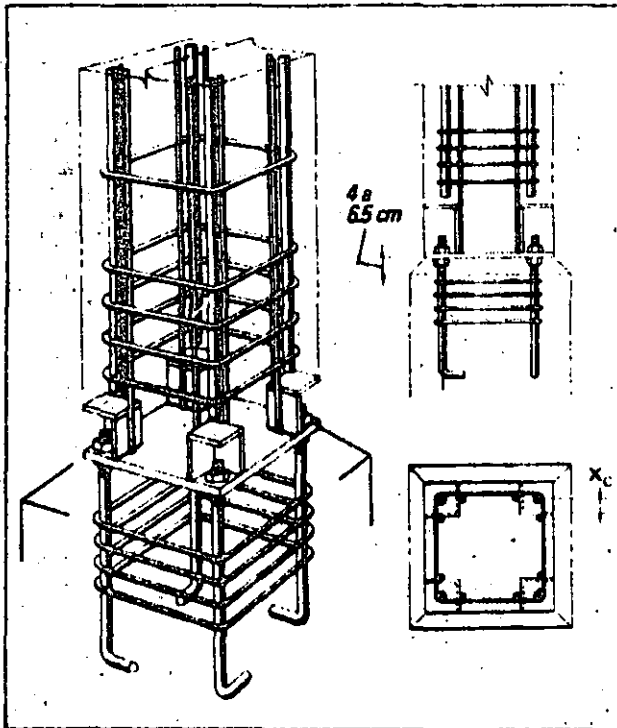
Placas de base de columna iguales o menores que la sección transversal de la columna
